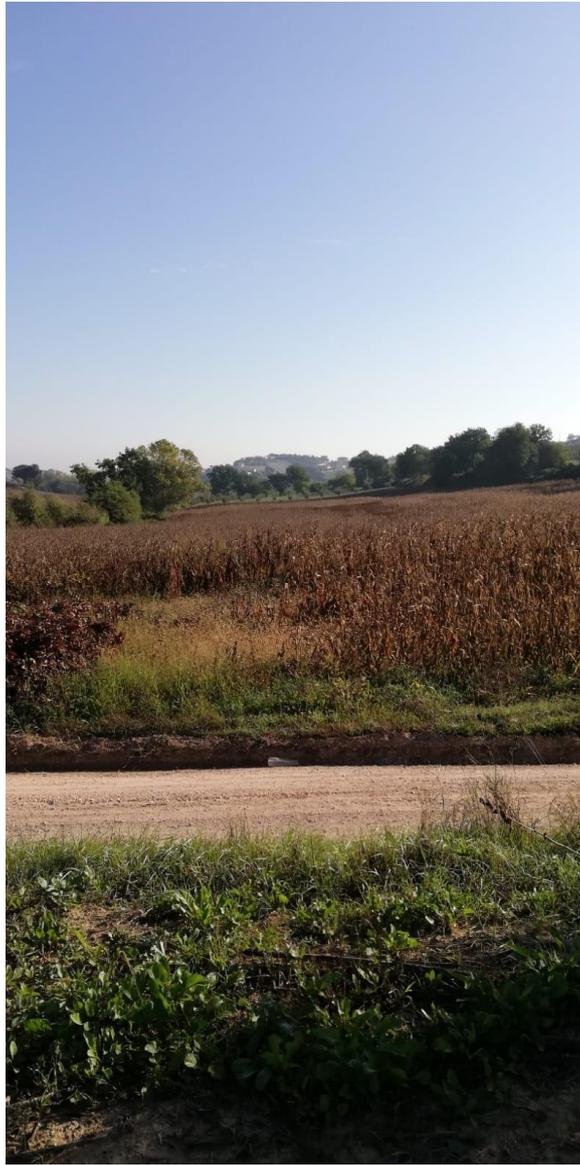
Zona compresa fra Picchetto n.8 e n.7 -
